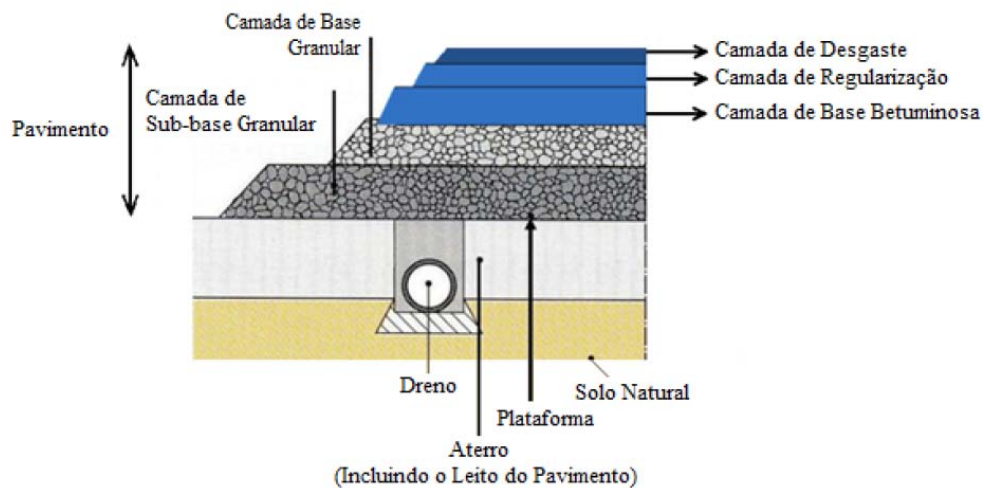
Esquema da estrutura de um pavimento rodoviário (Fonte: InIR)
